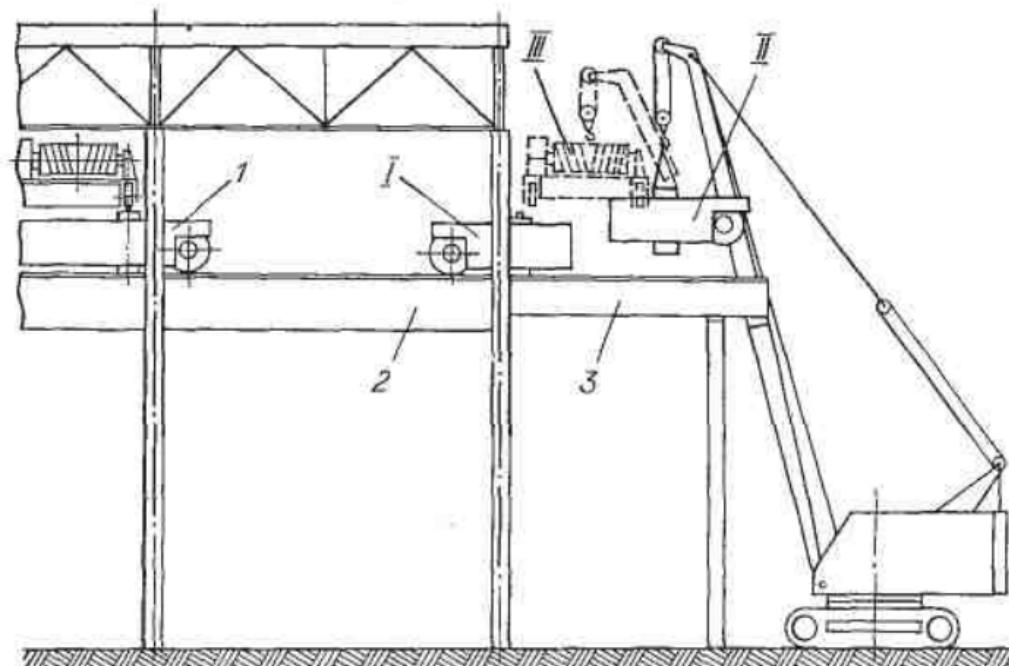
Схема монтажа мостового крана с использованием временных подкрановых путей в торце здания:
